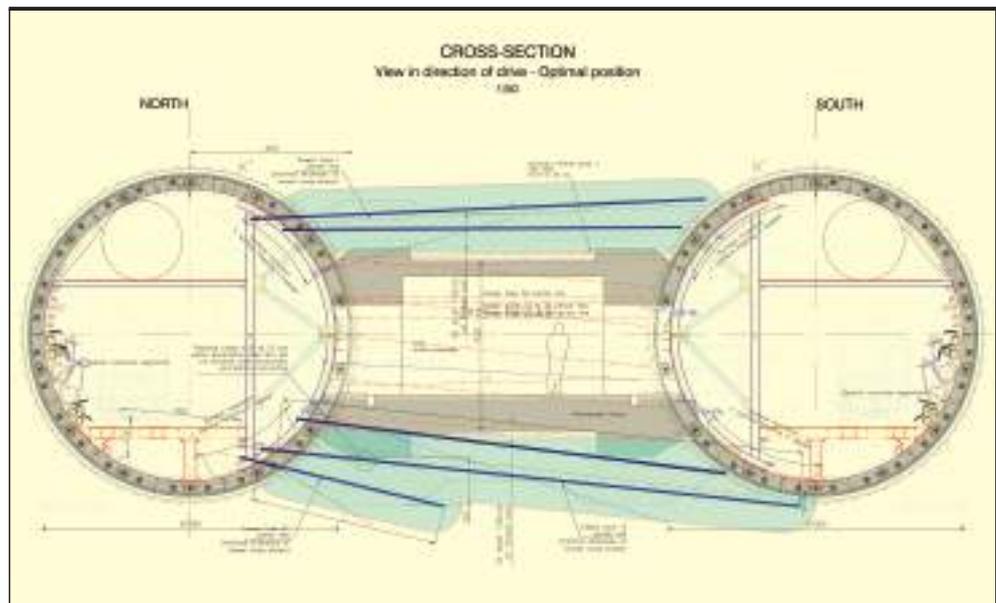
Sección longitudinal de una galería transversal entre túneles.
